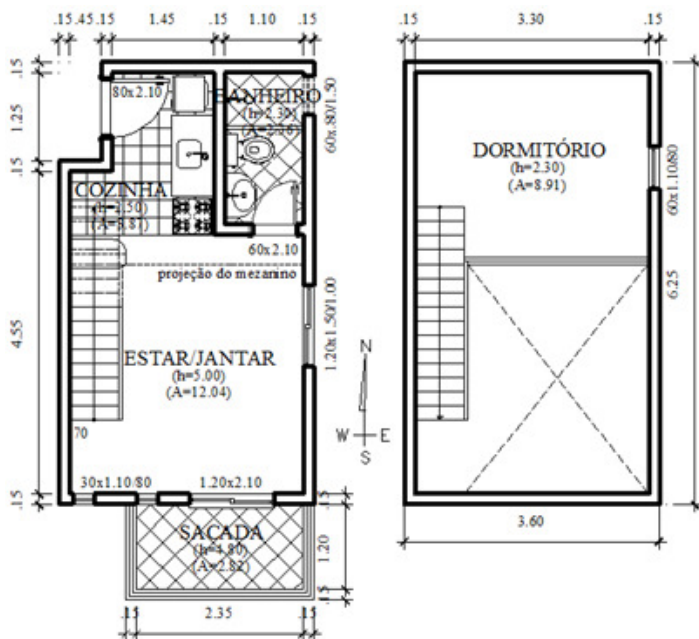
Planta baixa da Habitação D, com área útil de 30m<sup>2</sup> e tipologia 7: a) Primeiro pavimento e b) Mezanino.
